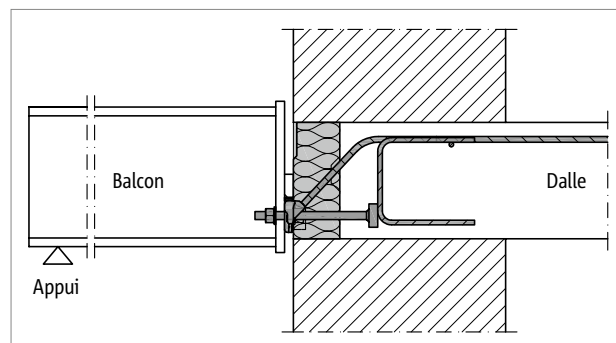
Schöck Isokorb® T type SQ : raccordement à la dalle en béton armé ; mur avec isolation répartie
